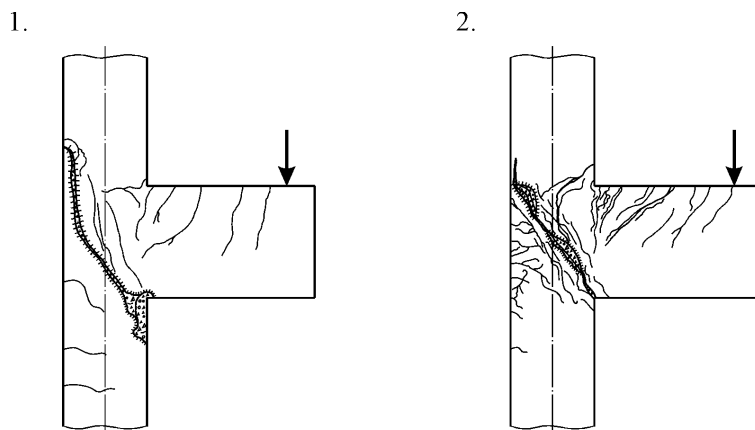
Схемы разрушения монолитных узлов сопряжения колонн с ригелями многоэтажных зданий (НИИЖБ, 1974 г.): 1 – разрушение по диагональной трещине; 2 – раздробление сжатого бетона с последующим срезом
